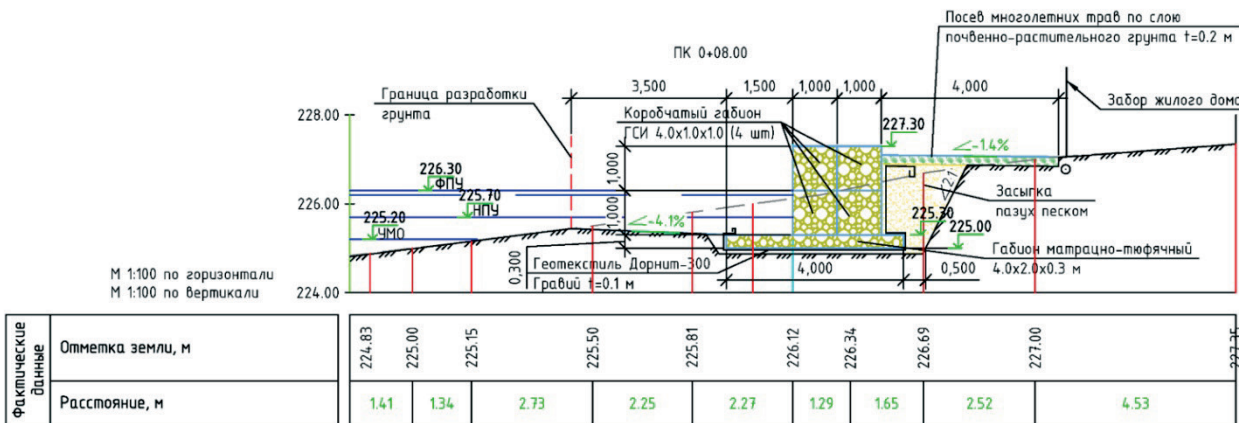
Берегоукрепление габионными конструкциями левого берега в верхнем бьефе водохранилища.
